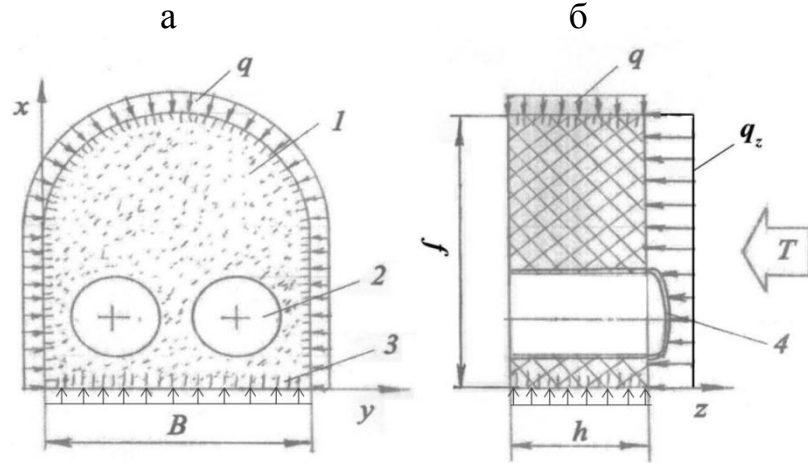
Расчетная схема взрывоустойчивой перегородки
